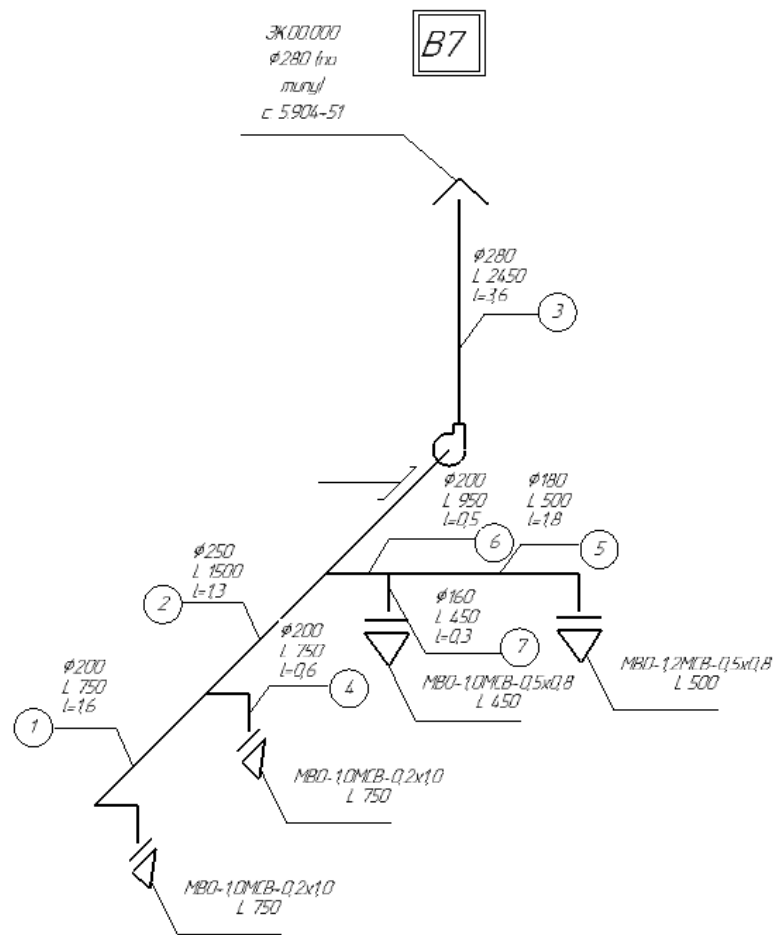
Схема вытяжной вентиляционной системы В7
